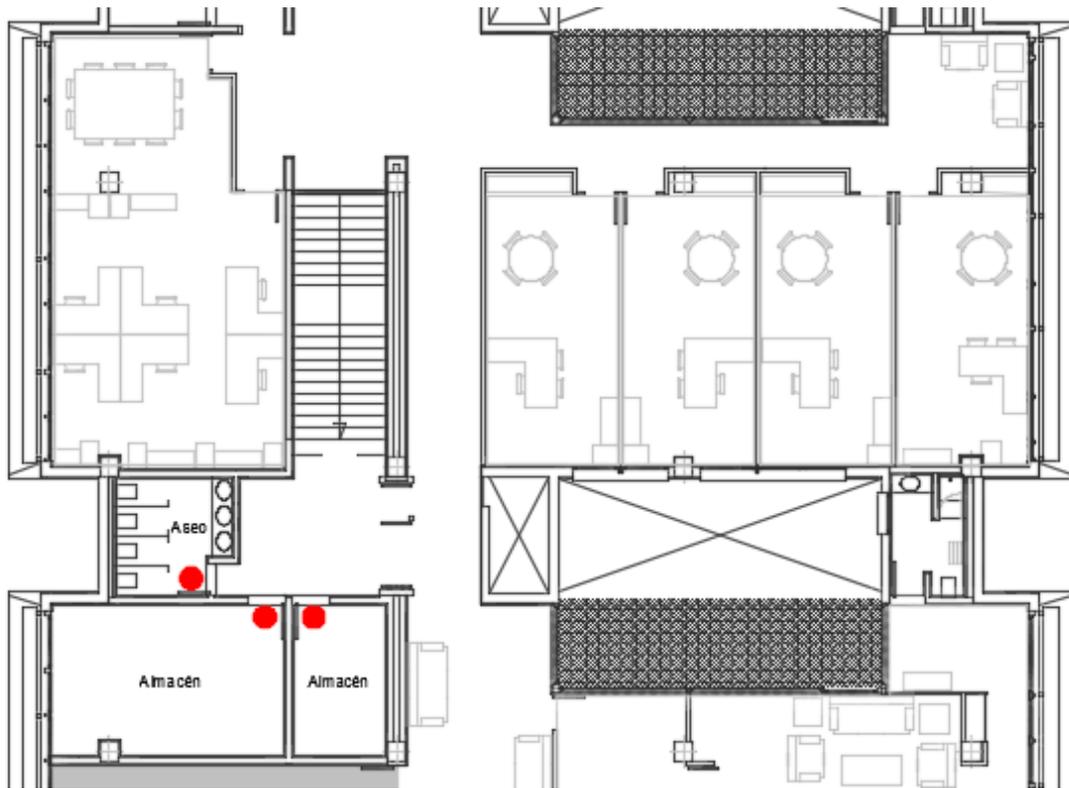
Cumplimiento Escalera Protegida Planta Tercera. Figura extraída del plano 5.
